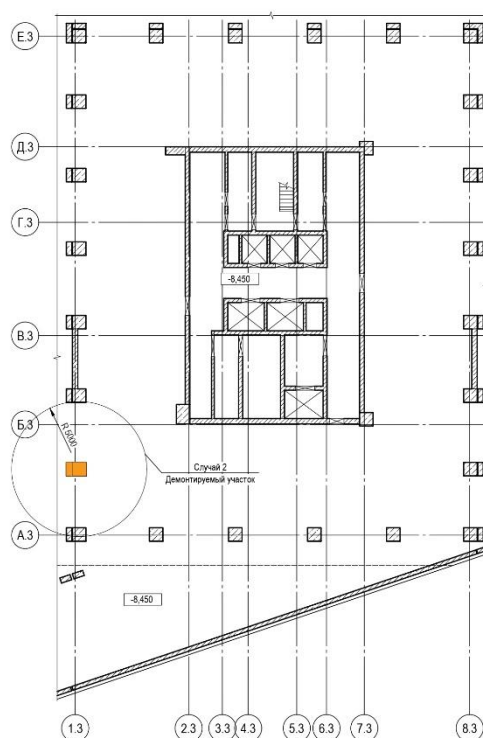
Корпус К-3. Схема аварийного случая 2
